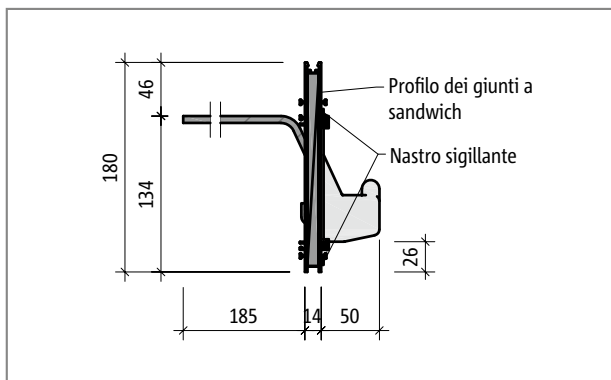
Schöck Tronsole® tipo T, sezione dell'elemento T...-H180
